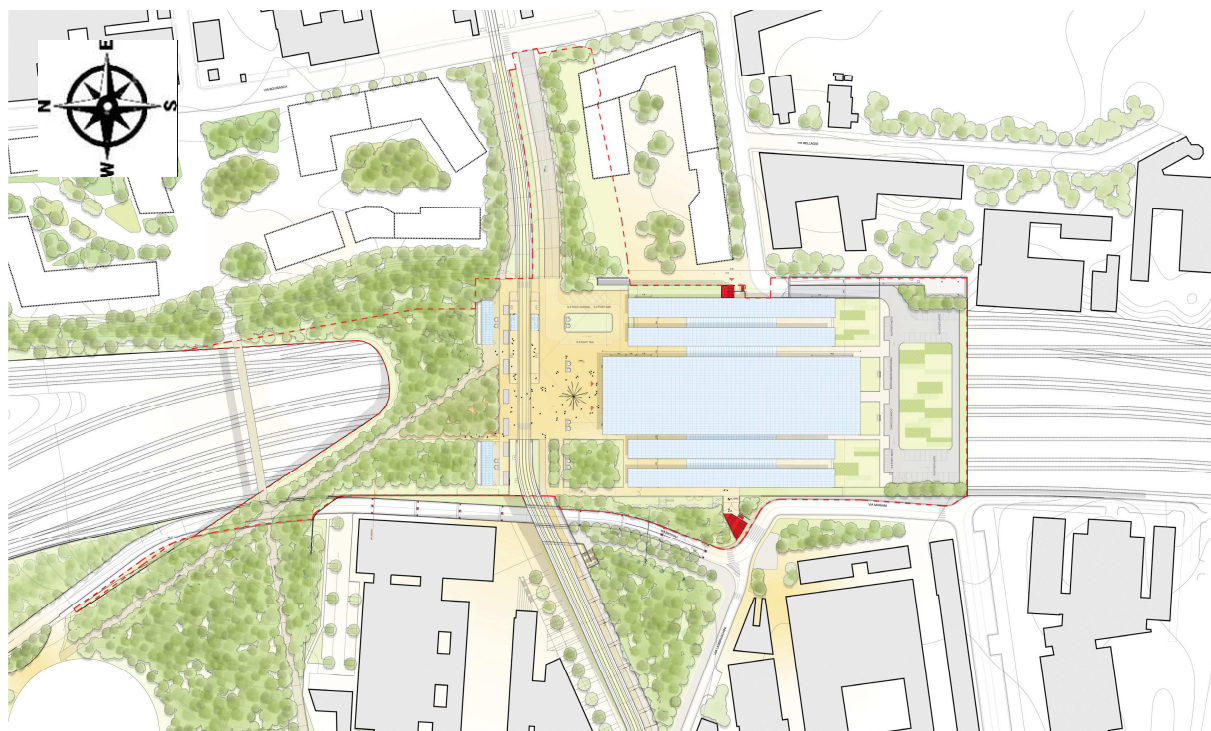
Planimetria generale 2D dello stato di progetto – stazione ed aree circostanti
